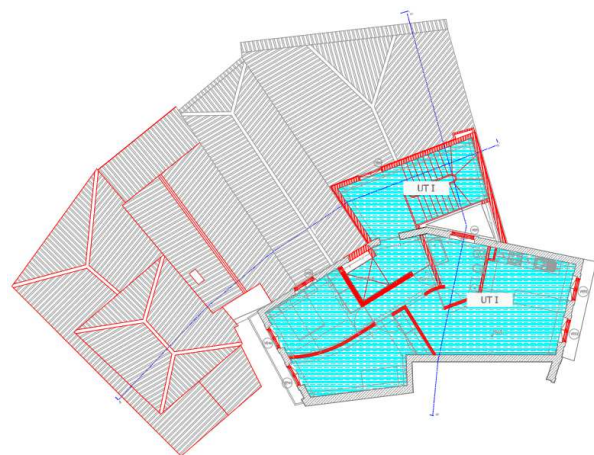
Planta da Parcela 26: 4º Piso
